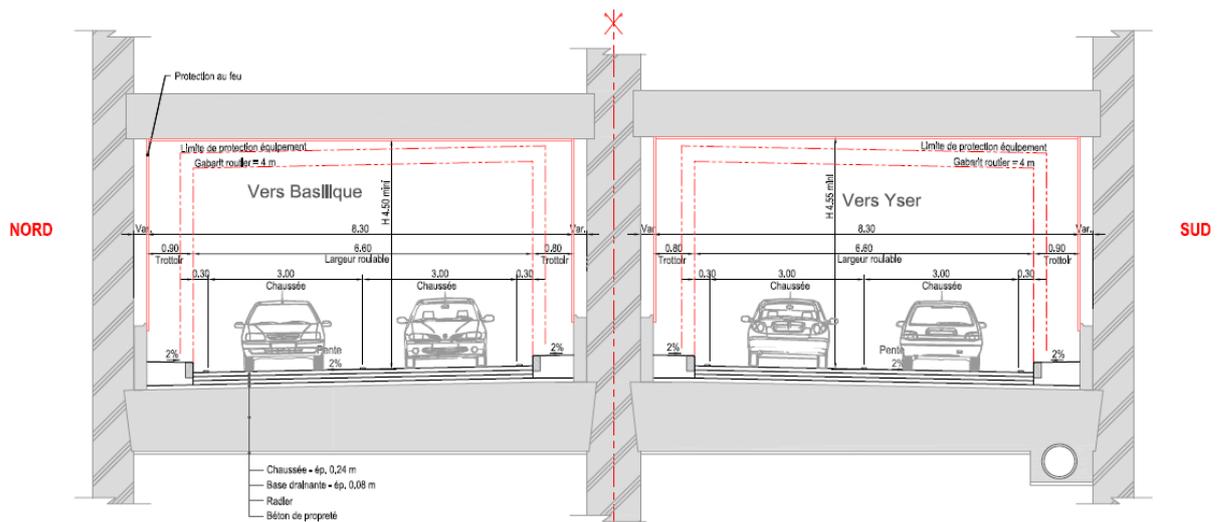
profil en travers type en section courante du tunnel Léopold II
